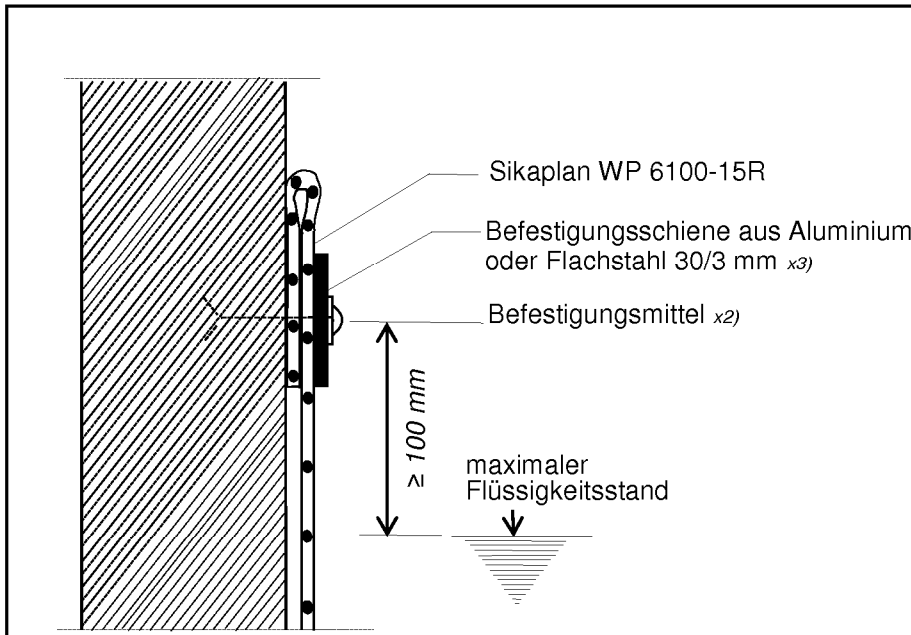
Randverwahrung mit Klemmschiene (Detail A)
